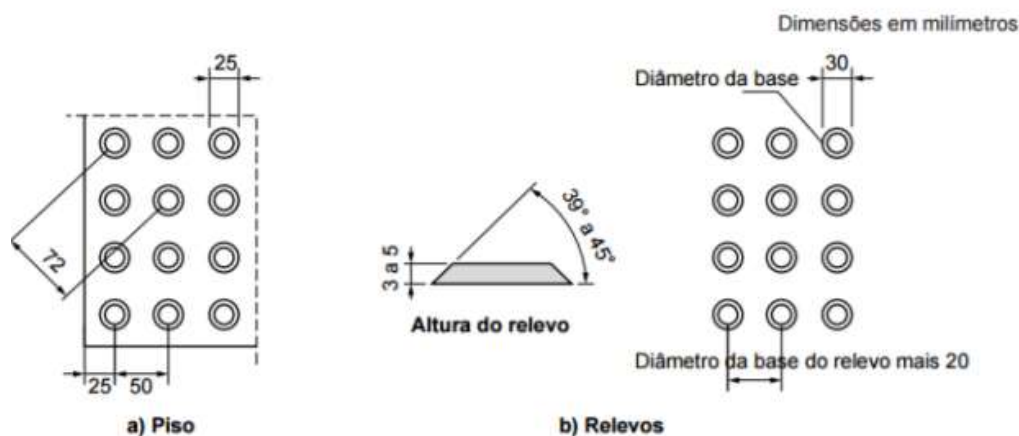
Sinalização tátil de alerta e relevos táteis de alerta instalados no piso. Fonte: NBR 9050/2015.
